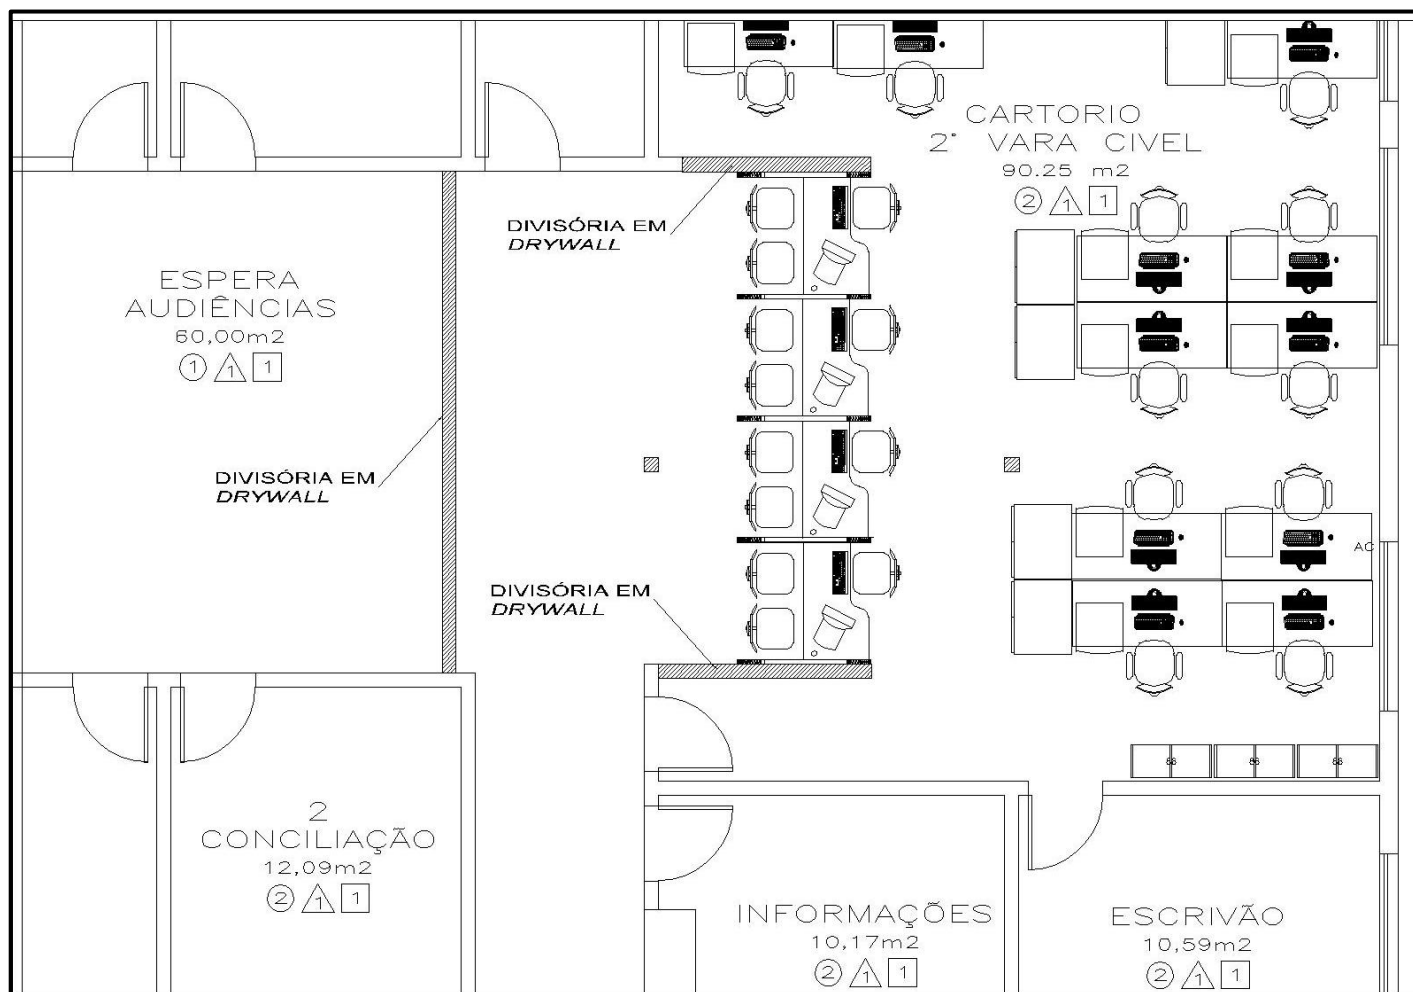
As hachuras representam as paredes executadas em *drywall*.
